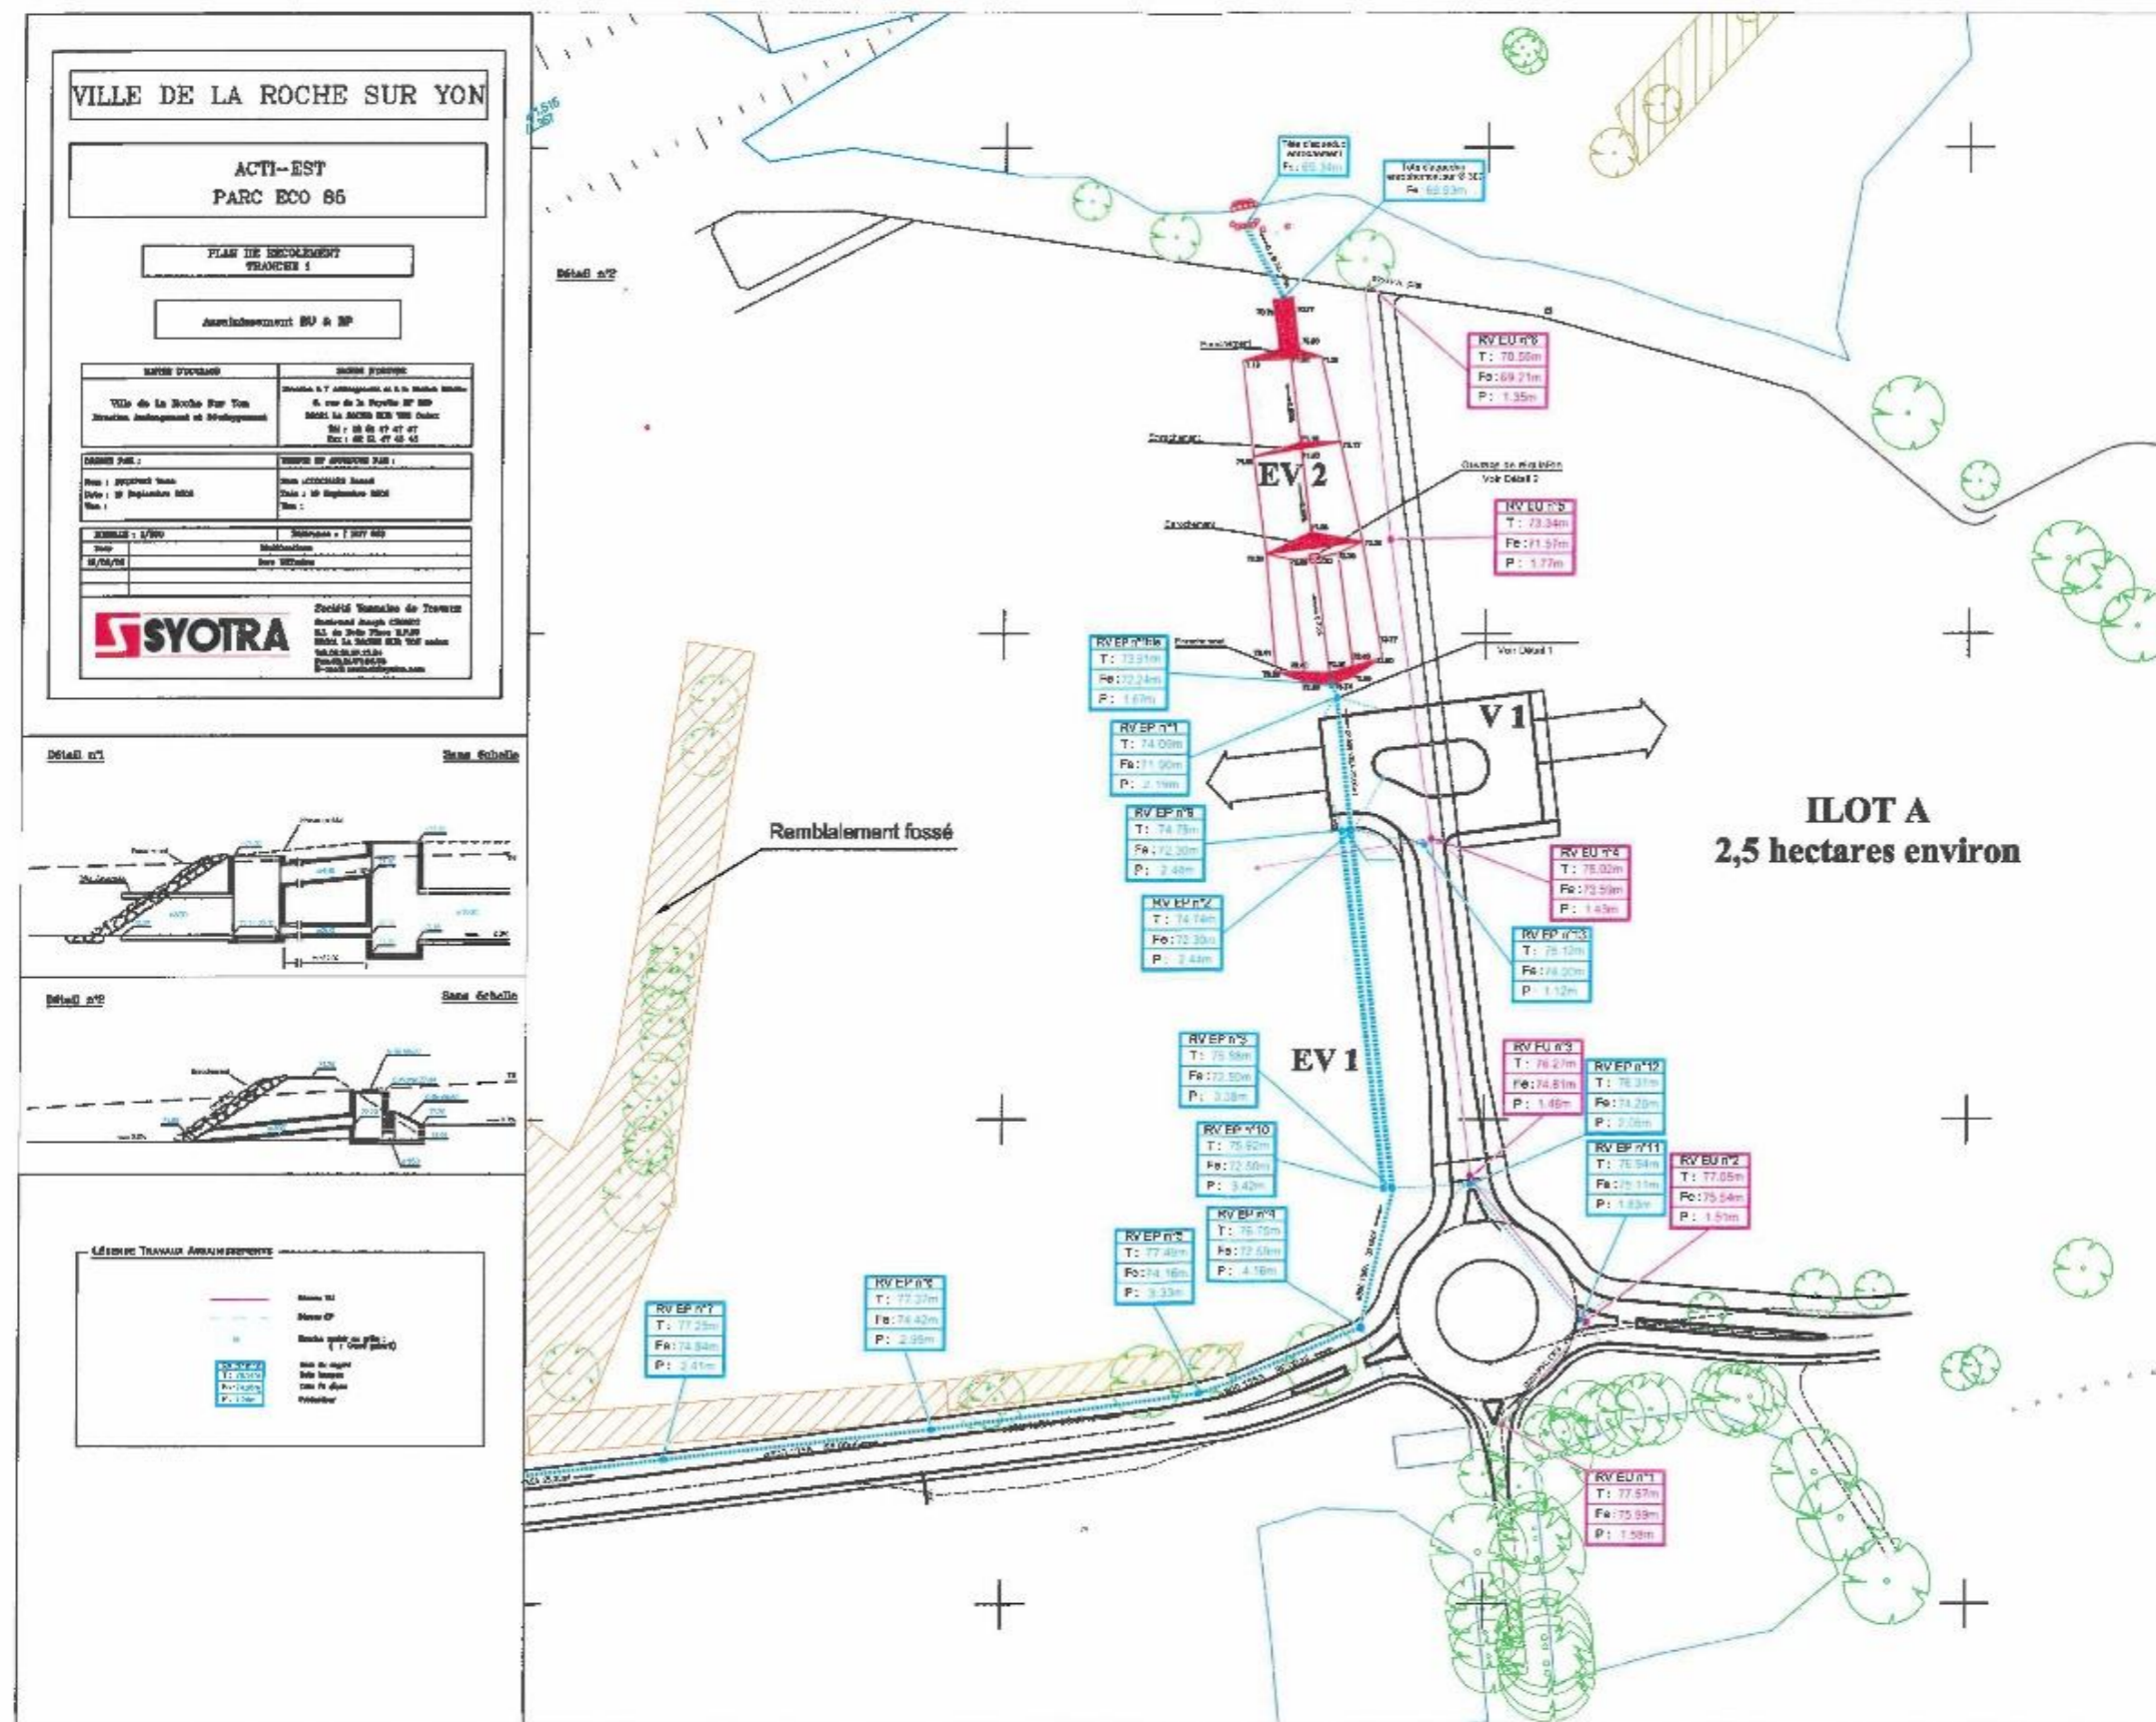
Plan de récolement EU/EP du Parc ECO 85 (Source : Ville de la Roche-sur-Yon)
